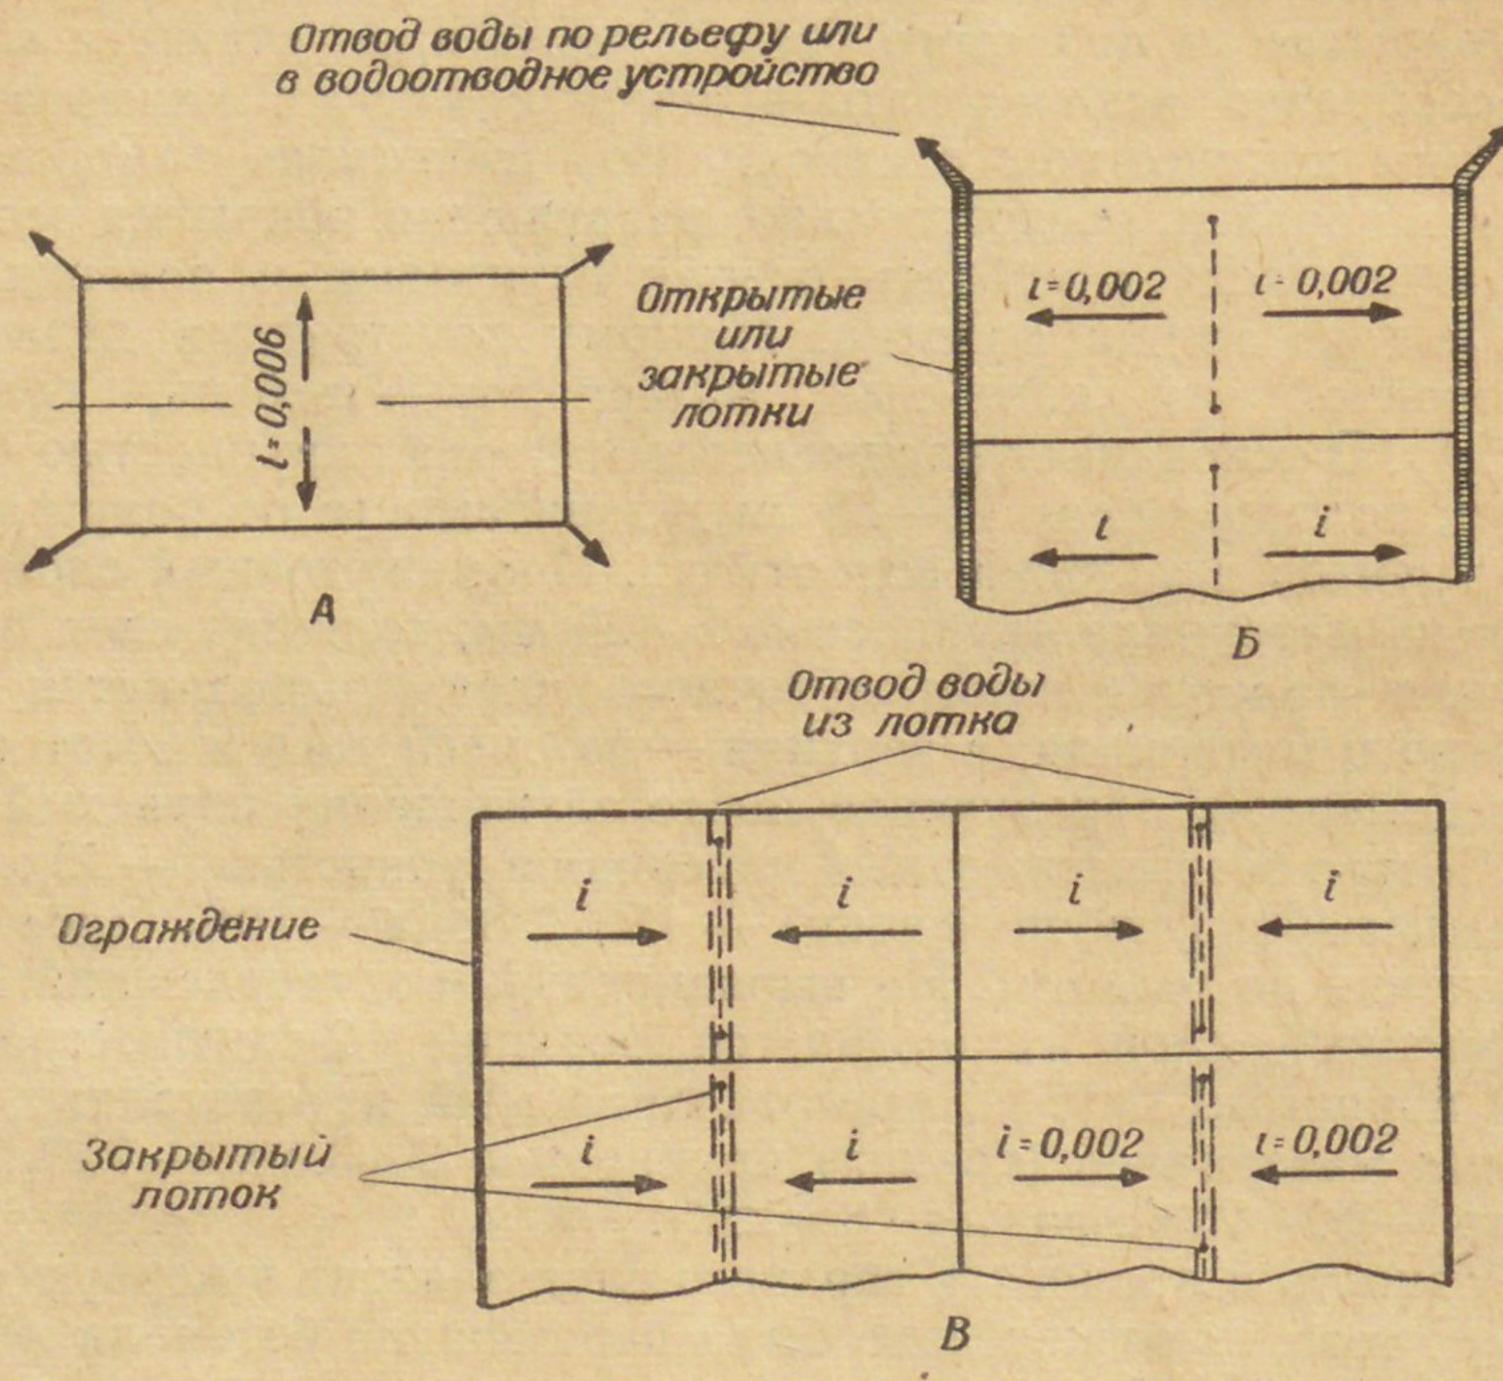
Схемы вертикальной планировки и водоотвода с поверхности отдельно стоящих и сблокированных площадок A — отдельно стоящая площадка; B — площадки, расположенные в один ряд; B — площадки, расположенные в два (и более) ряда
